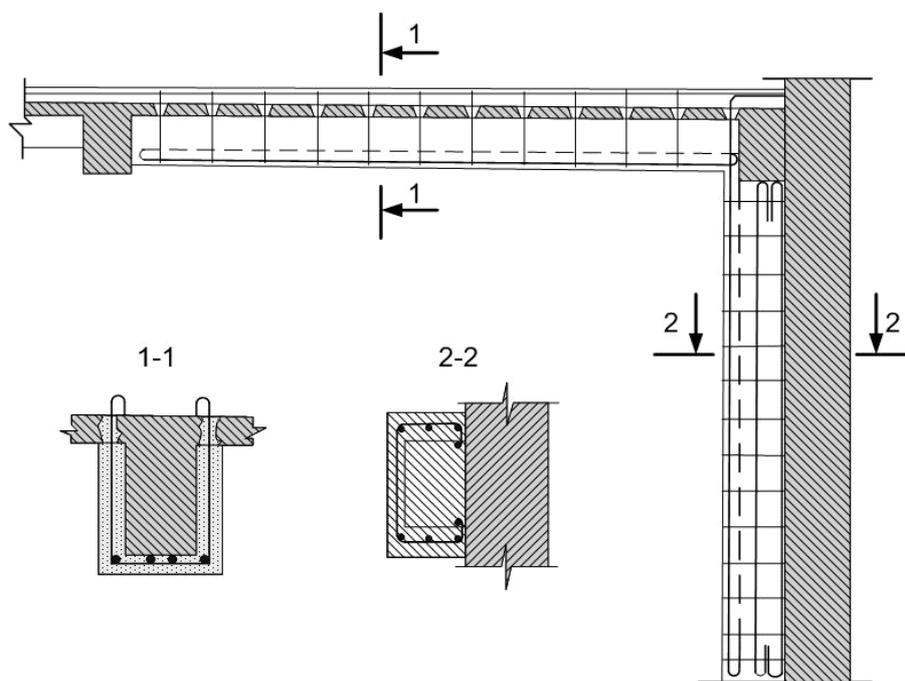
Усиление монолитной балки и колонны железобетонной рубашкой
